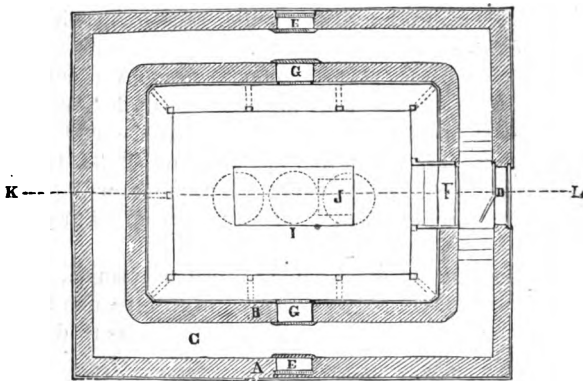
Plan de la fruiterie, suivant la ligne CH, de la figure 211.
